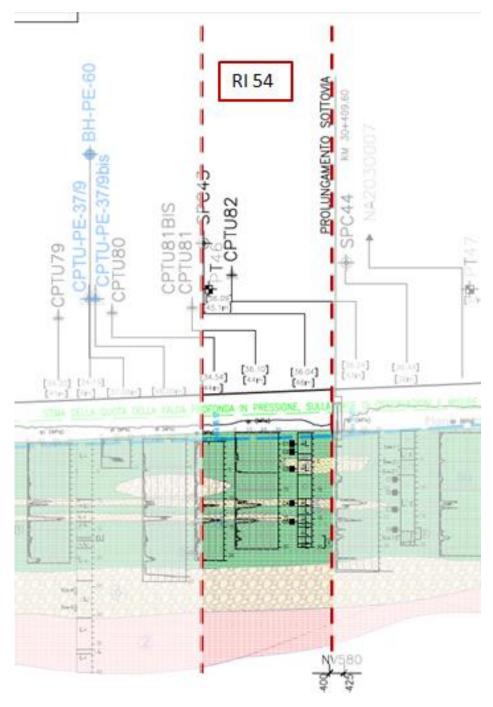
Profilo Geotecnico Rilevato RI54, estratto dal Profilo Geotecnico Generale (Doc. Rif. [3])
